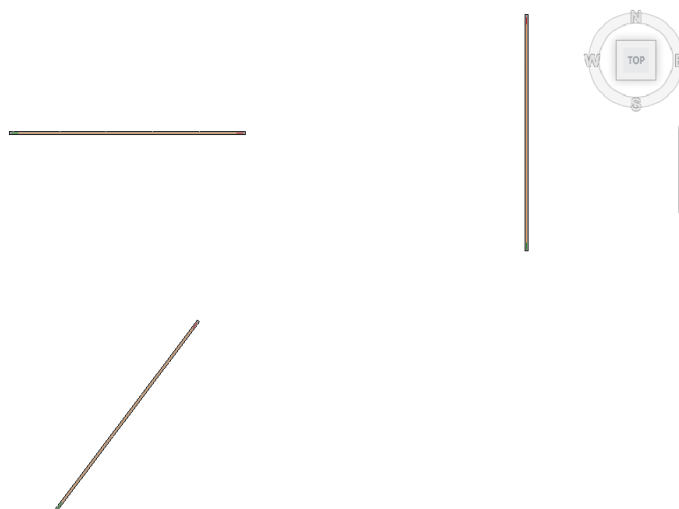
Vista em planta das vigas modeladas em ambiente BIM para estudo de caso.
